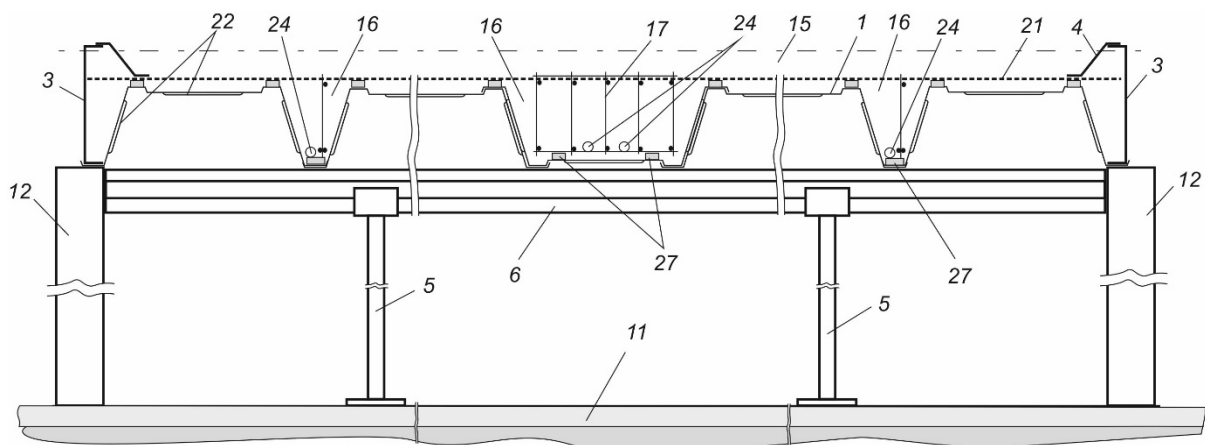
Сталежелезобетонное монолитное перекрытие с несъемной опалубкой,
